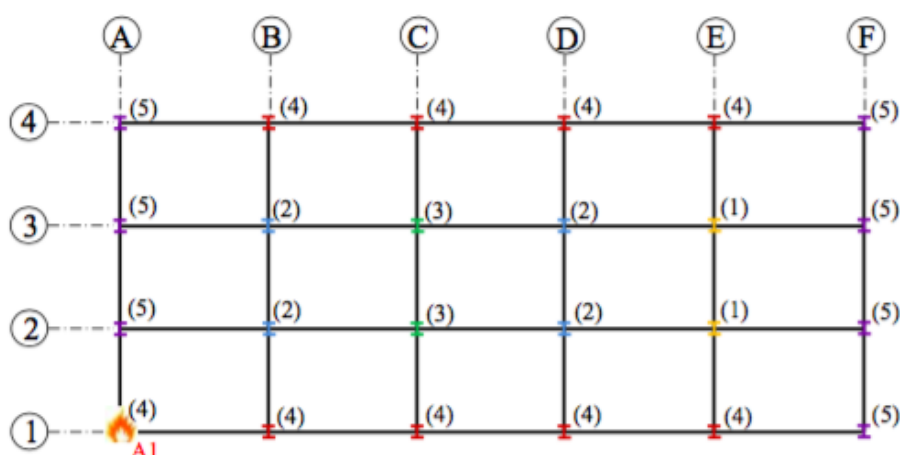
Planta do edifício com indicação do aquecimento pontual
